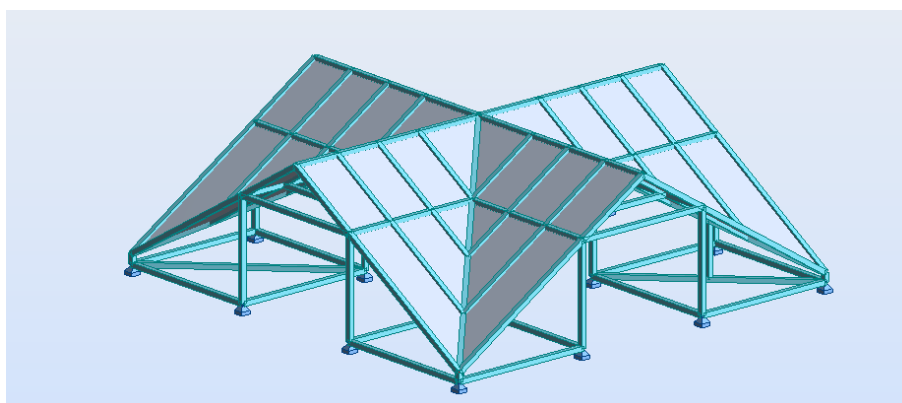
Oznaczenia dachów czterospadowych
